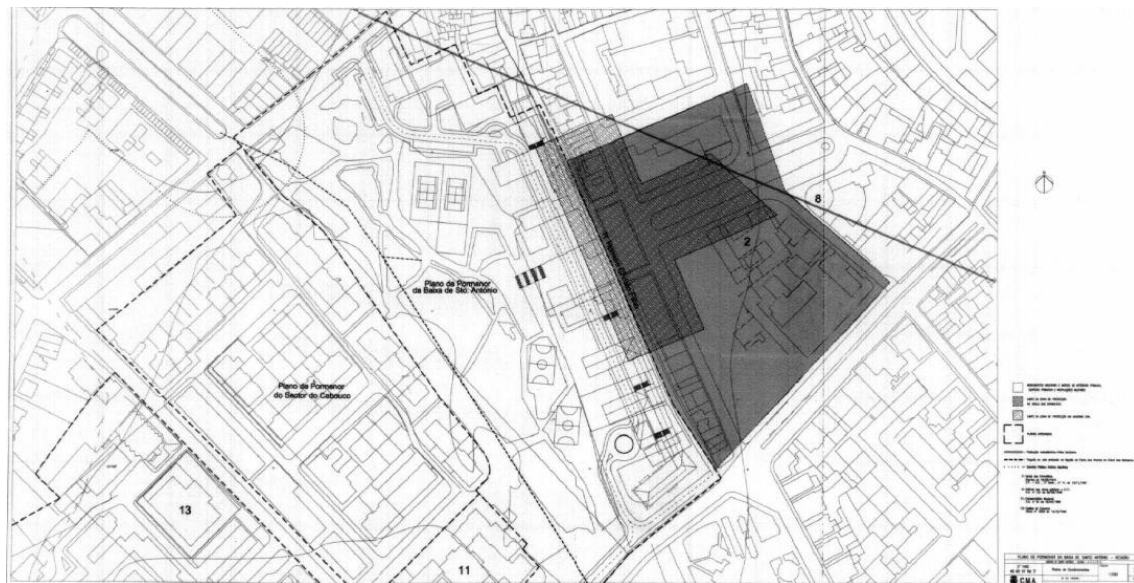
Plano de Pormenor da Baixa de Santo António (2004)
